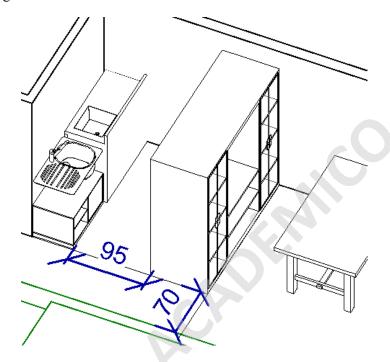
Situación real de la cocina dentro de la vivienda analizada.
